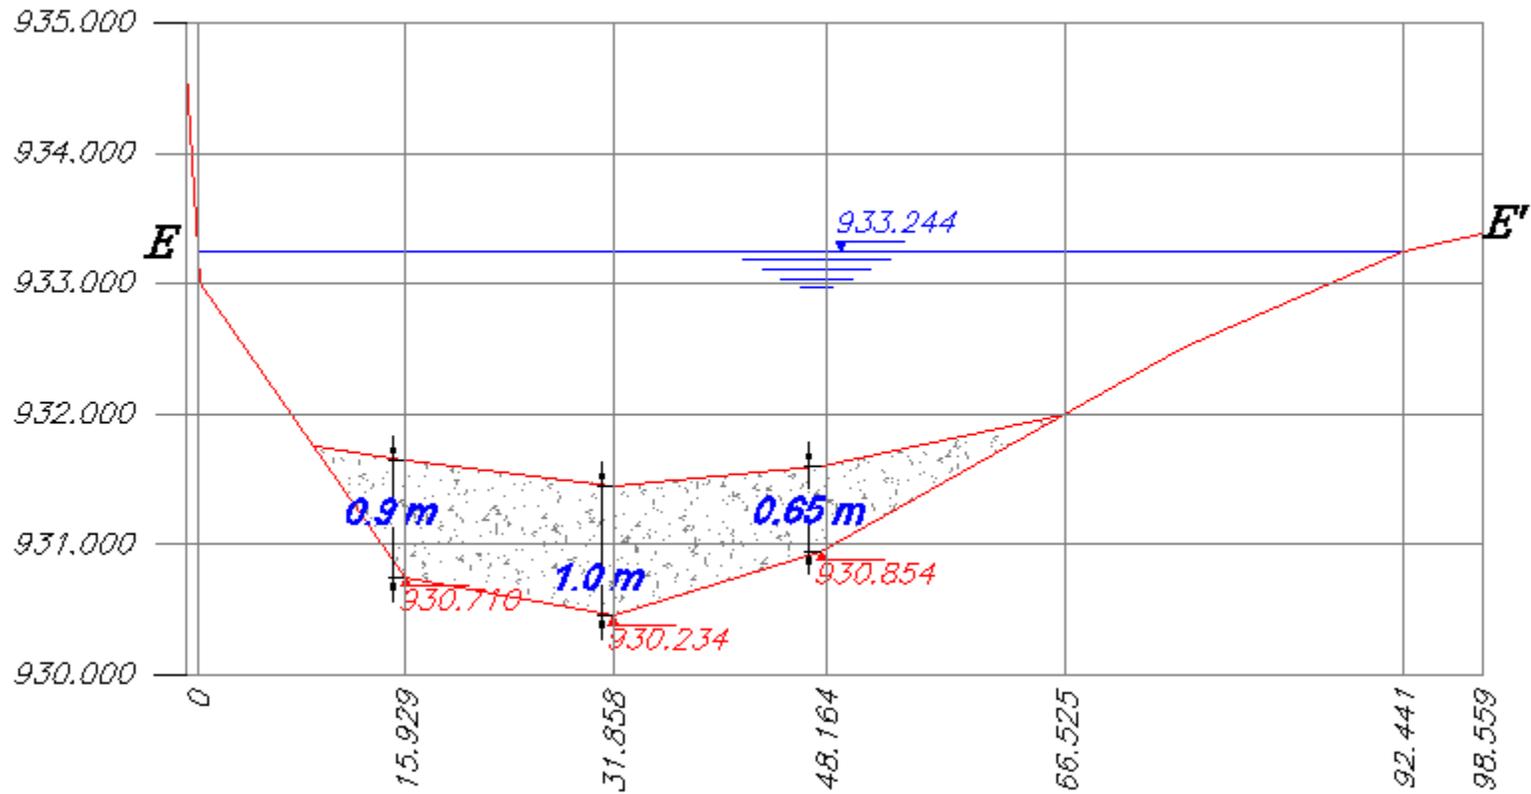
Perfil E – E' Madre Vieja Carabalo.
